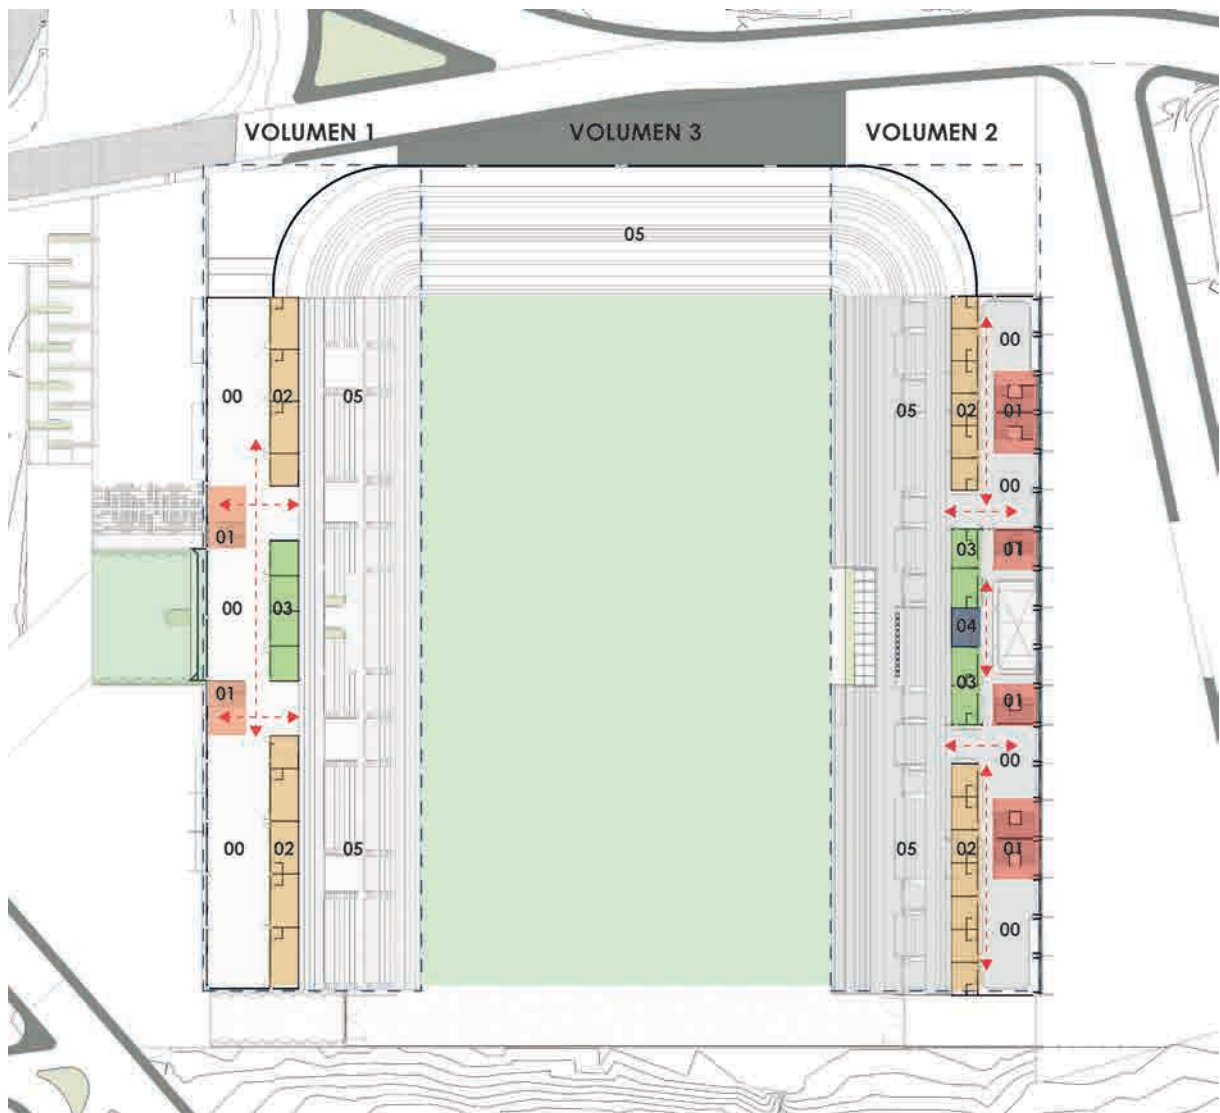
Segunda planta alta. Elaboración: Autores.
